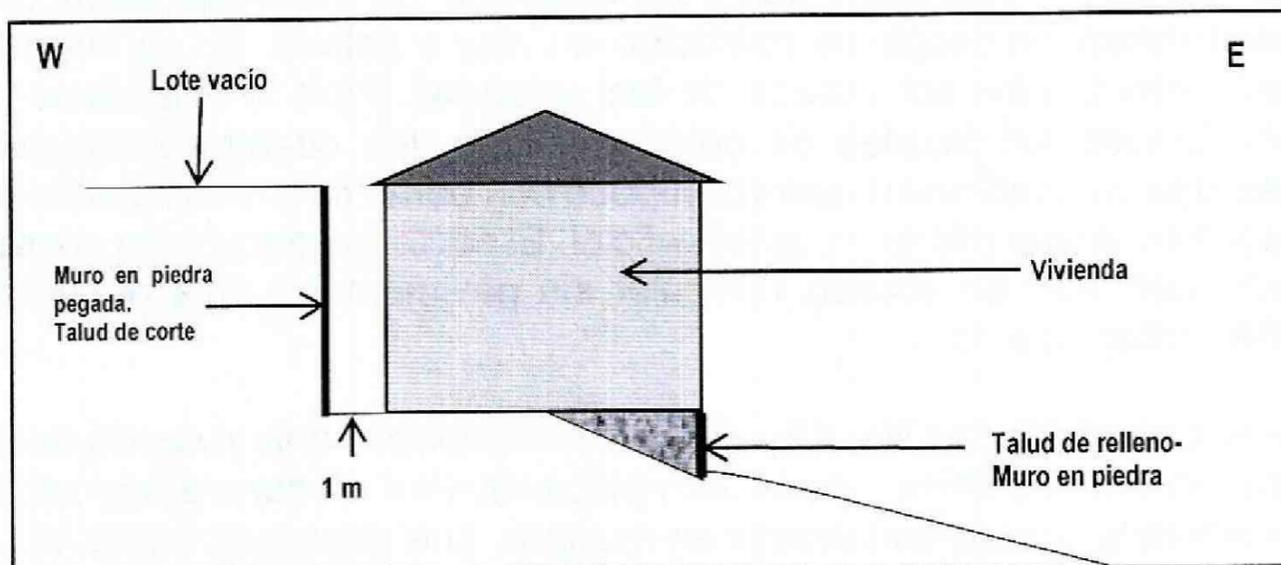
Perfil de la ubicación de la vivienda emplazada en la Calle 81G Sur No. 19 – 53, en el Barrio Arabia, de la Localidad de Ciudad Bolívar.
